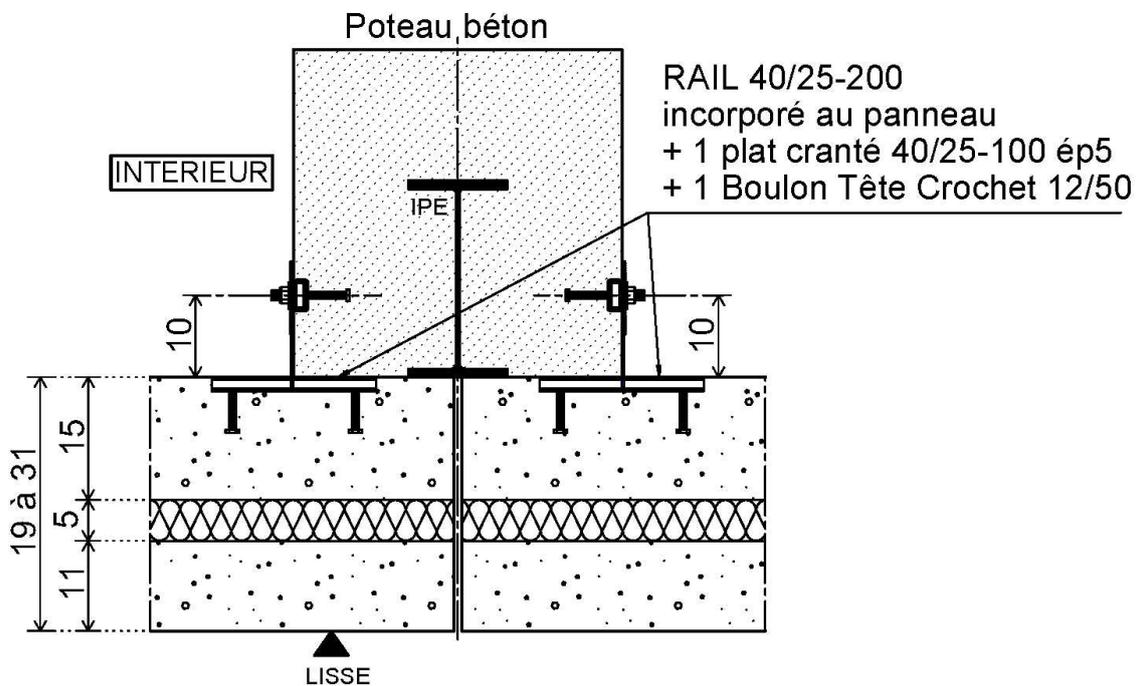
Façades de quai pour bâtiments industriel – coupe verticale – fixation sur poteau béton
